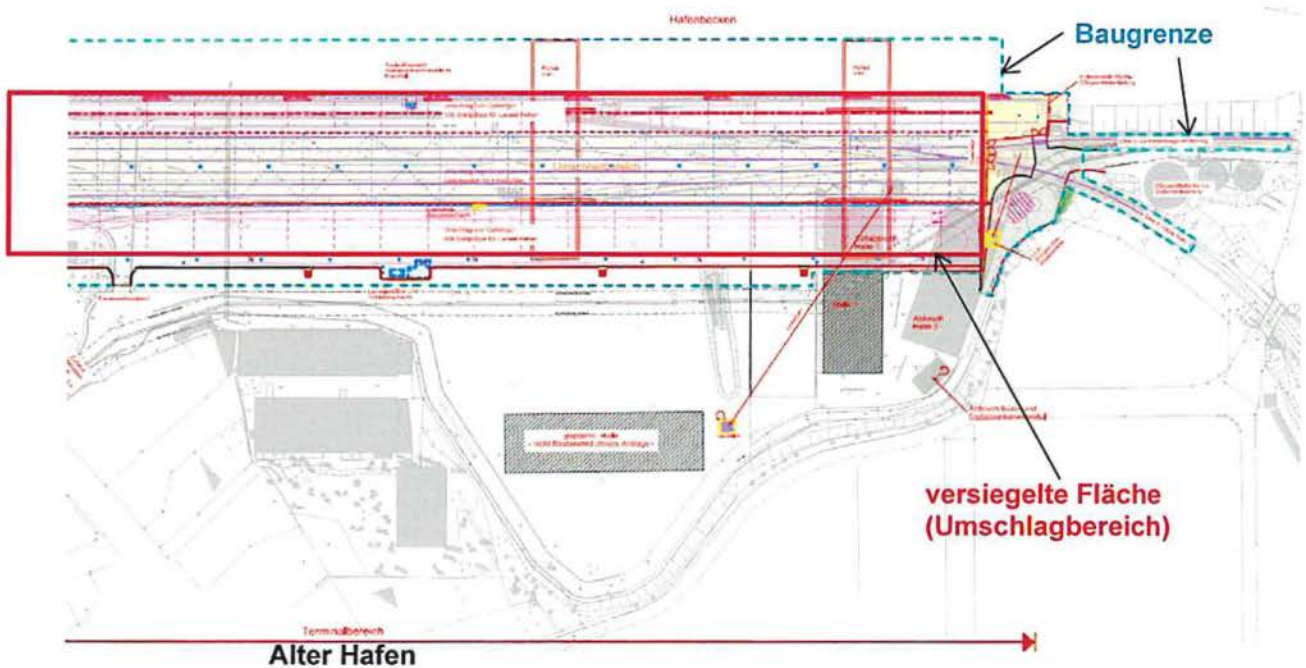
Ausschnitt Übersichtslageplan (duisport 05.05.2014) – östlicher Teil
